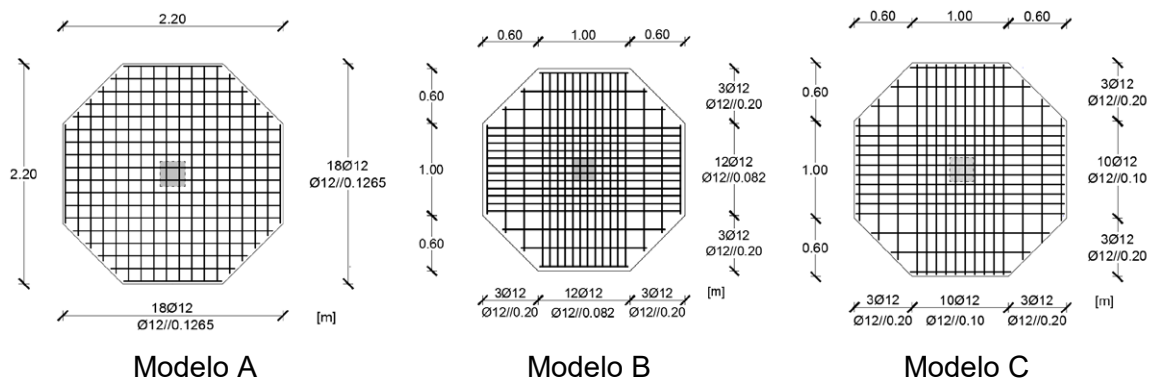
Distribuição de armaduras superiores lajes hexagonais
